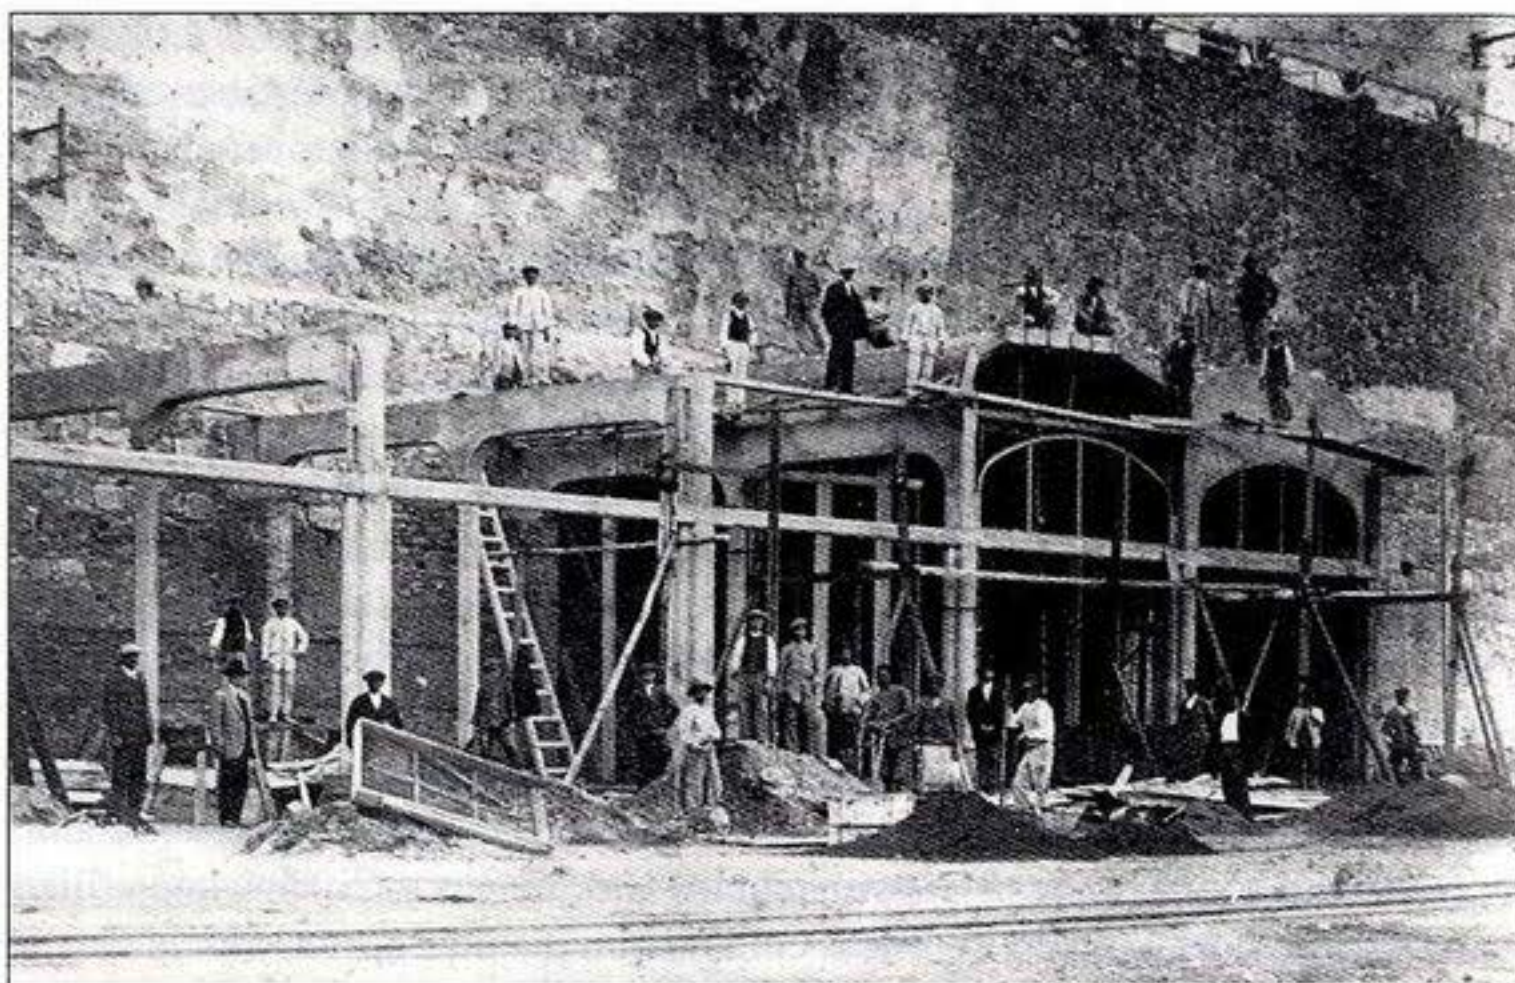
Estructura de hormigón armado utilizada por Tomás Moreno Lázaro en la nueva pescadería, 1915. APFC.
